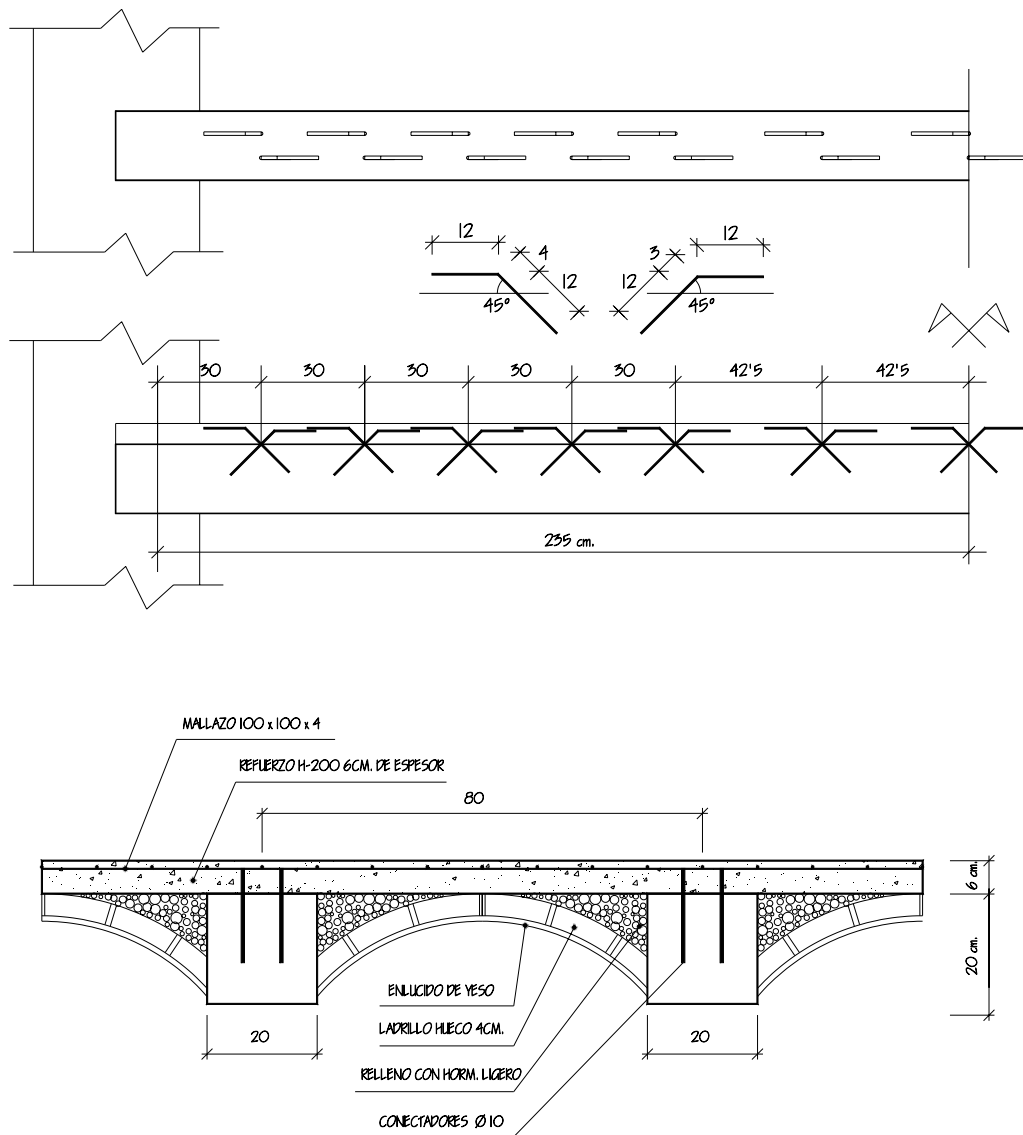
Dimensión de los conectores , situación en la viga y sección transversal del refuerzo.
